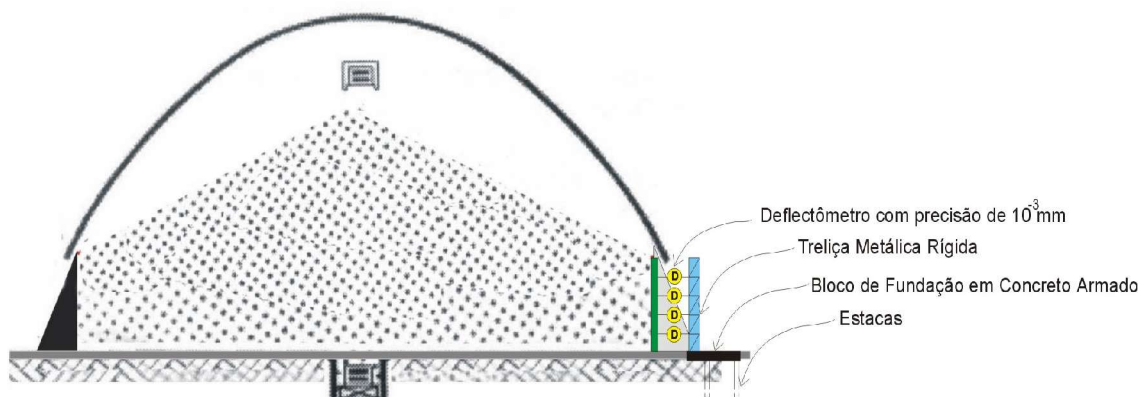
Vista da instalação de deflectômetros na parede do pavilhão.
